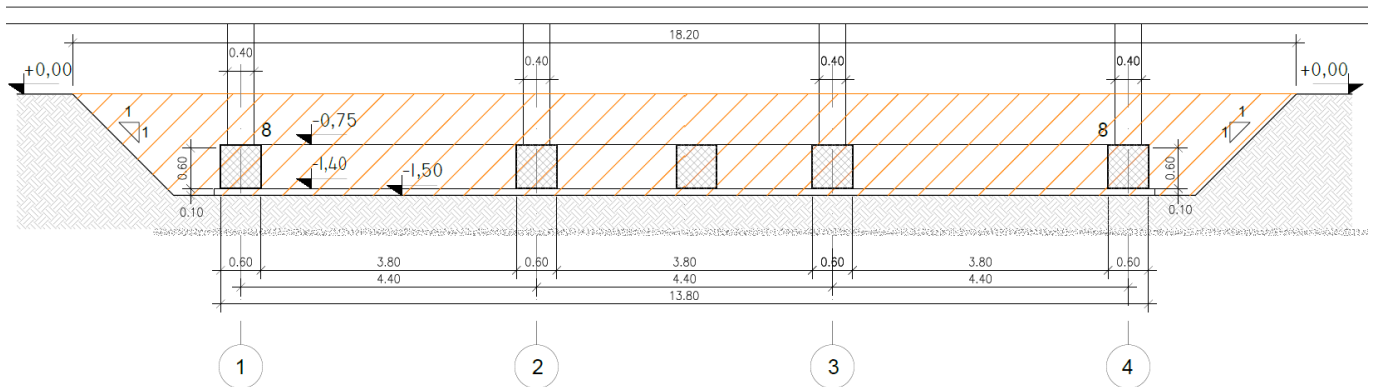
Esempio di sezione trasversale delle fondazioni tipiche per strutture come quella in progetto
